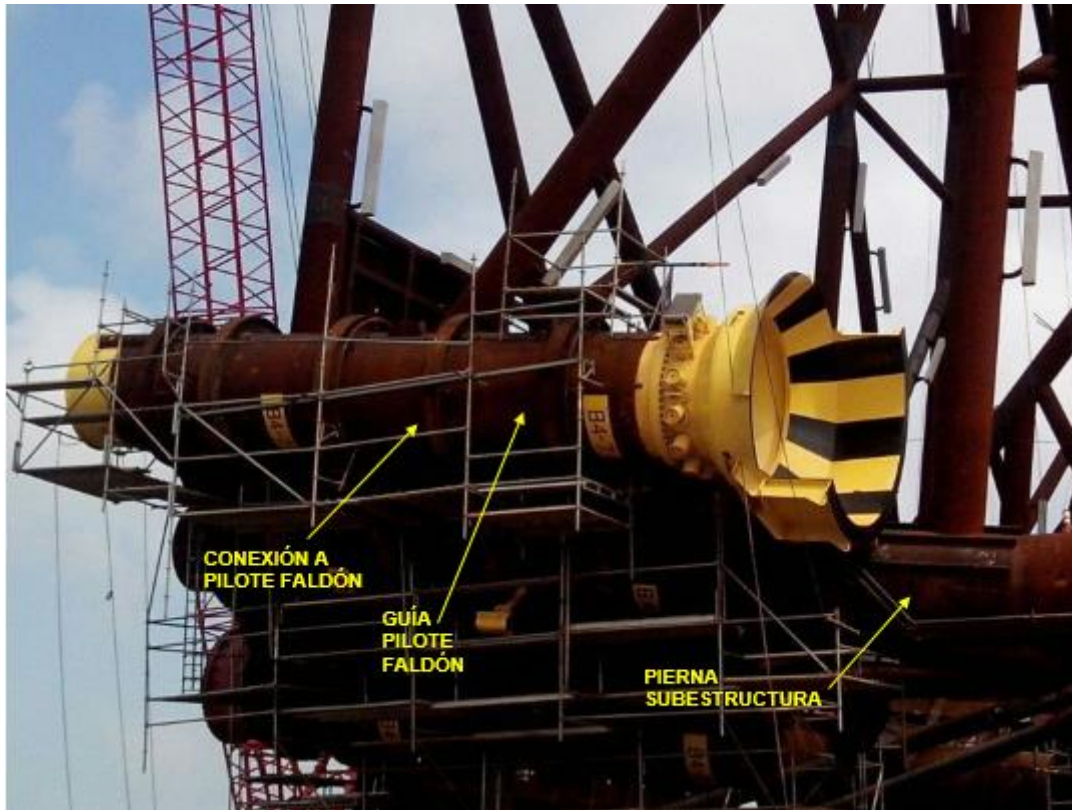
Secciones de acero en una conexión Subestructura con Pilote Faldón
